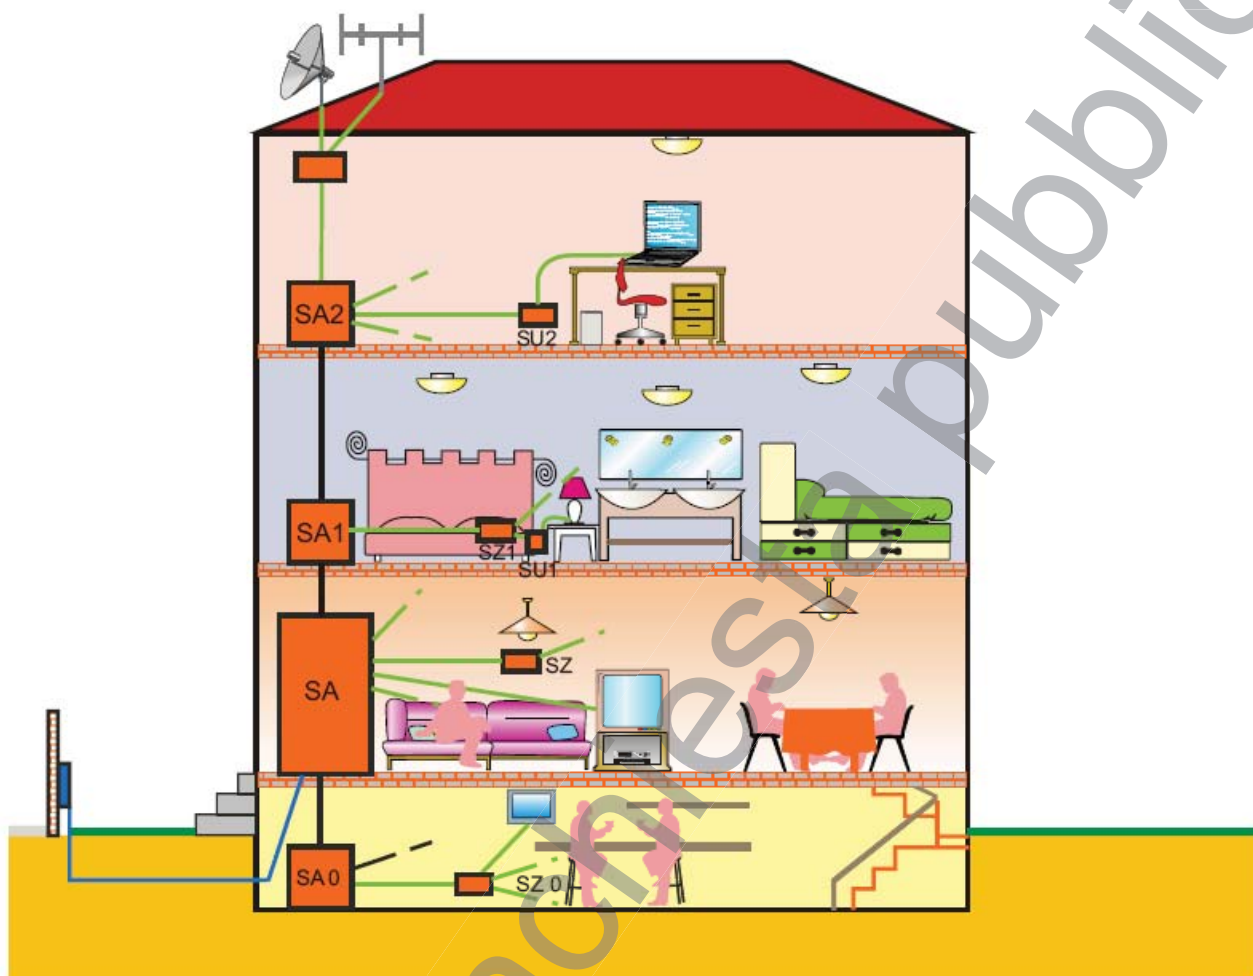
Infrastruttura per villa a più piani : SA principale di edificio con SA di piano
